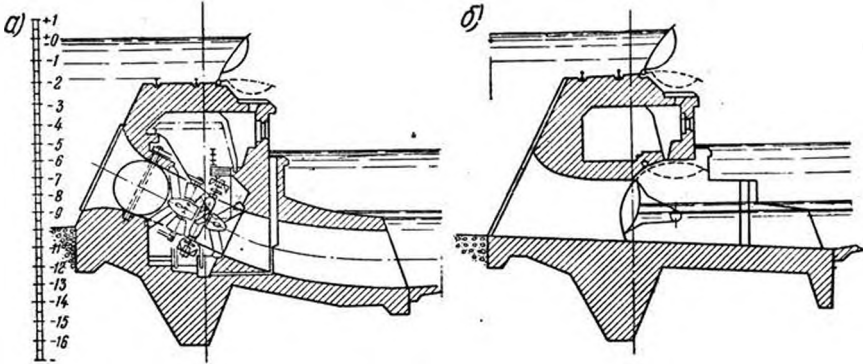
14. Здание ГЭС внутри железобетонного водослива
